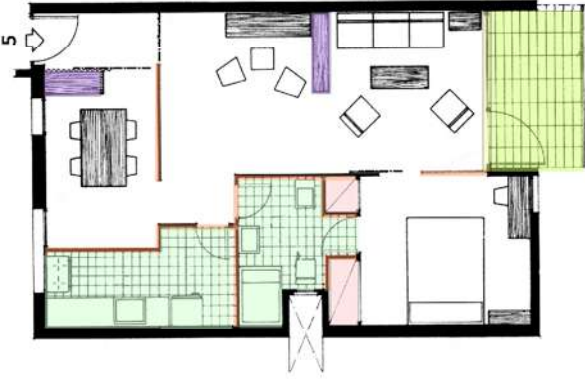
Planta do Apto Tipo 5 Escala: 1/200
